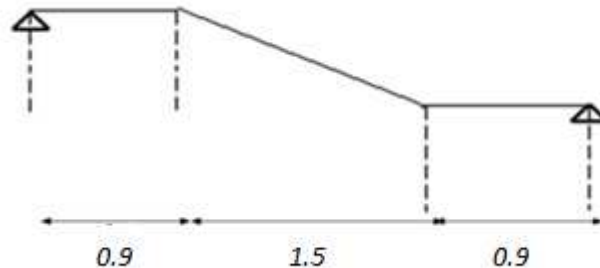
Un tronçon d'escalier de l'étage à deux paliers avec paillasse intermédiaire.
